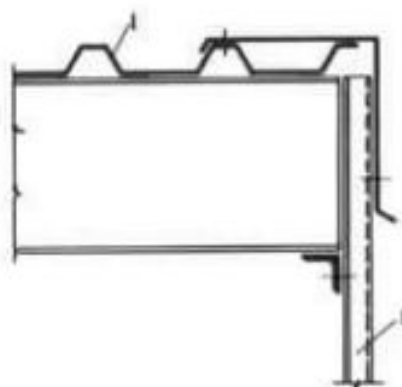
DETALHES DE COBERTURAS COM TELHAS TRAPEZOIDAIS
